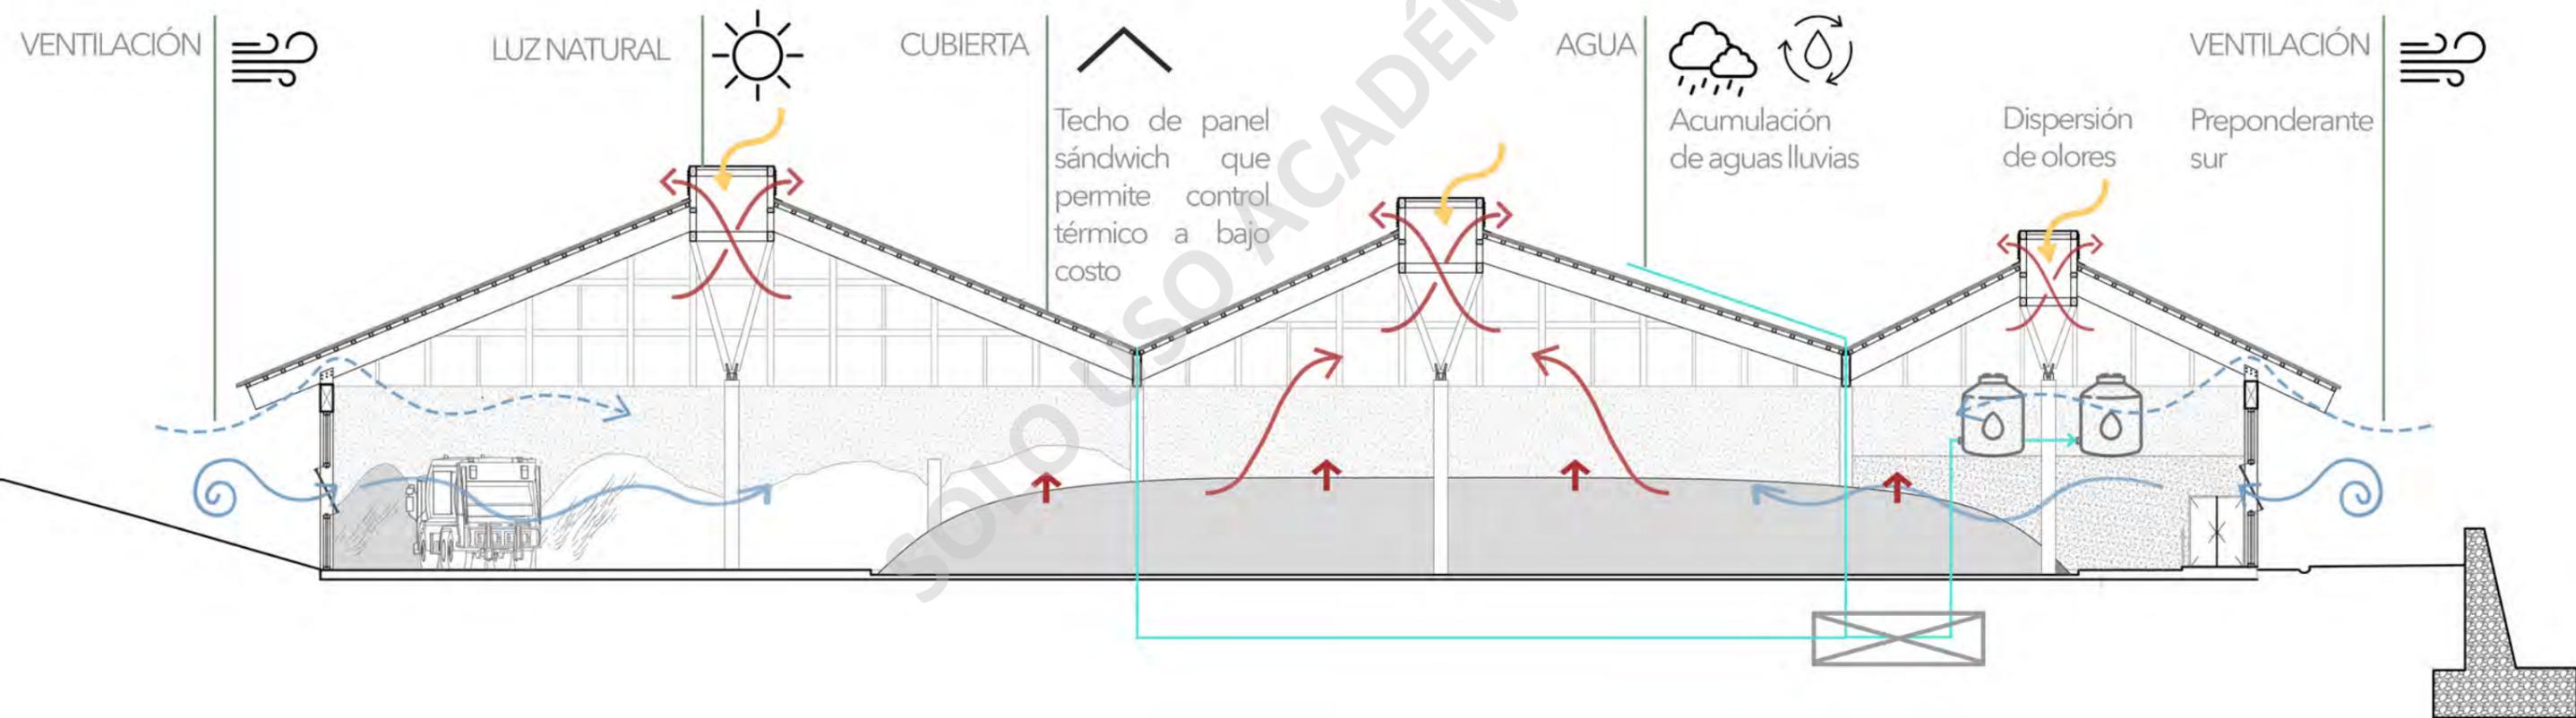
Corte bioclimático de la planta de compostaje. Planimetría de elaboración propia.
